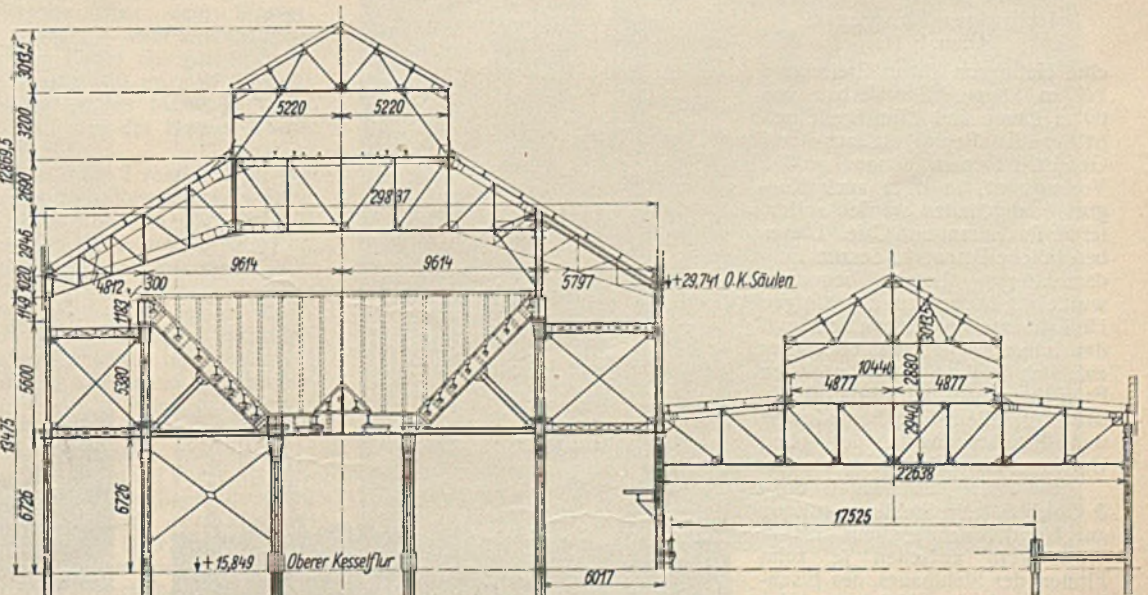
Querschnitt durch Kessel- und Maschinenhaus.
